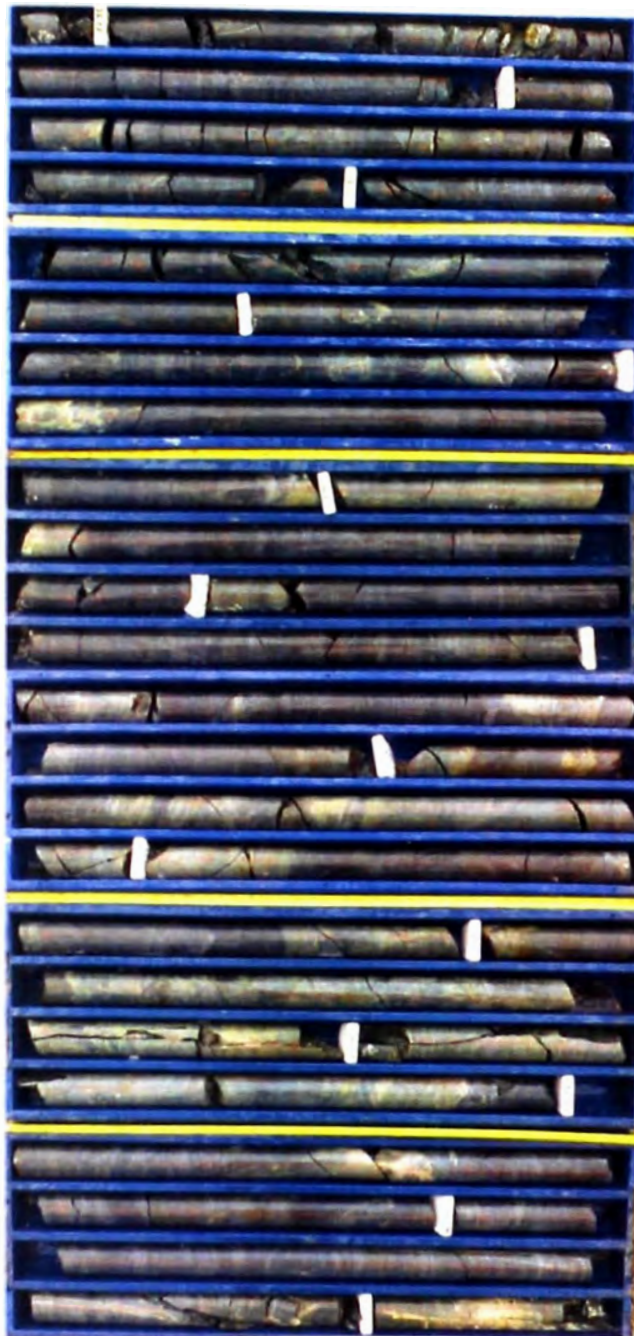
Perforación PR-02 de 22,2 m hasta 4 ,5 m.
